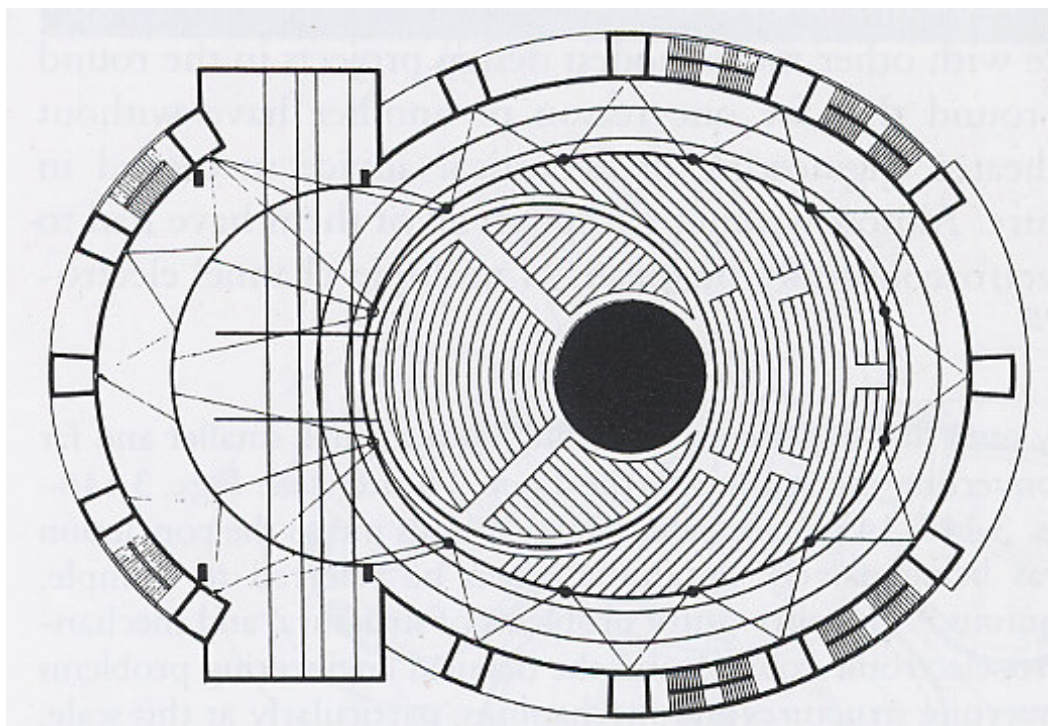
Pianta del Totaltheater, disposizione ad arena.
